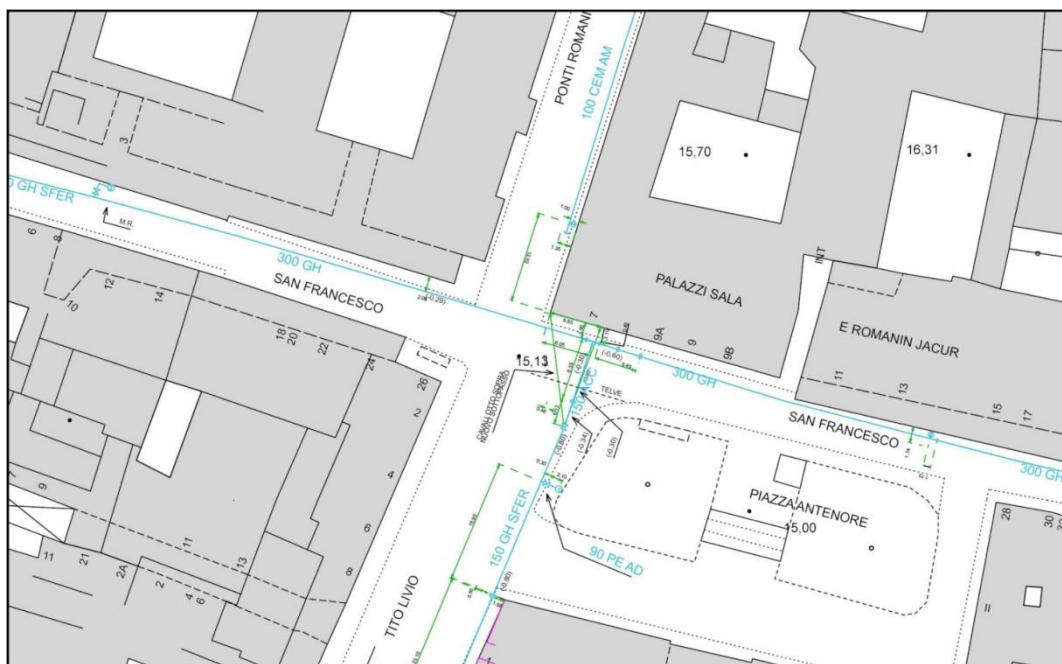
Planimetria con le tubature dell'acquedotto (AcegasAps).
